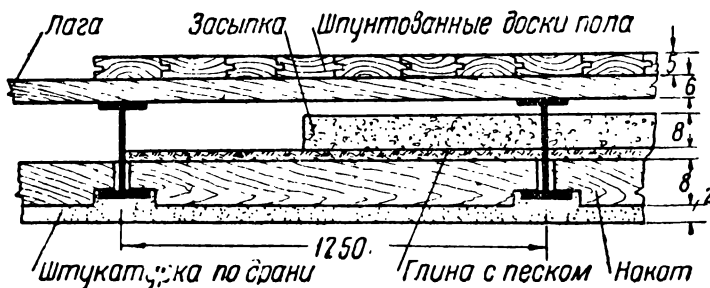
Разрез междуэтажного перекрытия по двутавровым балкам.
